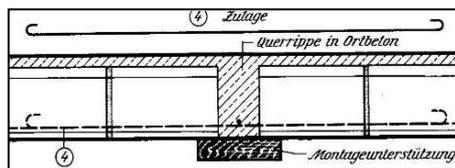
Kaiserdecke, Balkenstoß mit Ortbetonquerrippe [1b]
